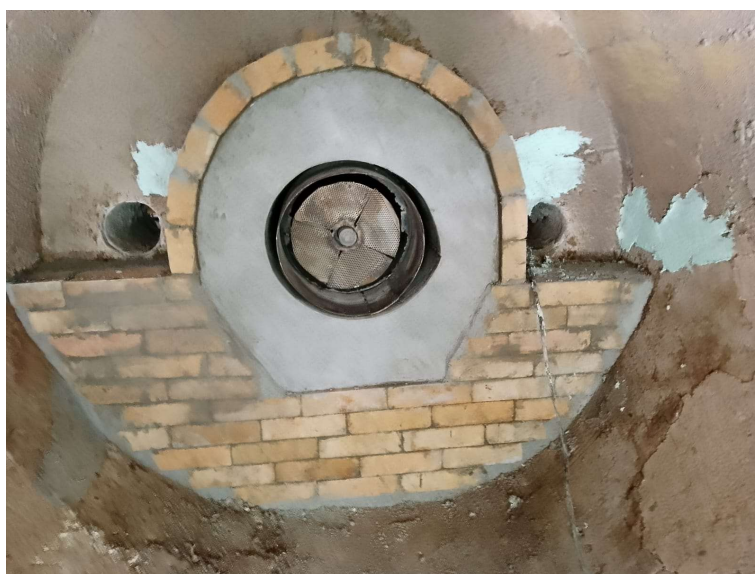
Finalização da parede de tijolos com aplicação do concreto denso no aro do queimador e início da aplicação de Siplatê.
